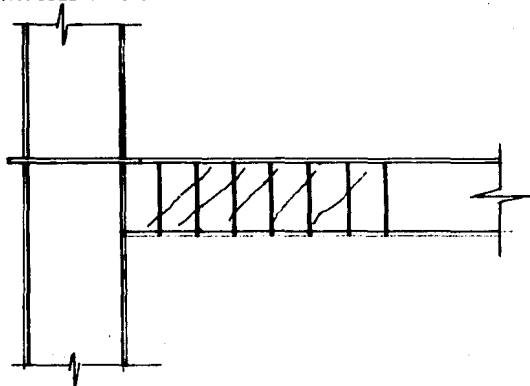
USO DE SOLERAS PARA REPARACION DE VIGAS .
